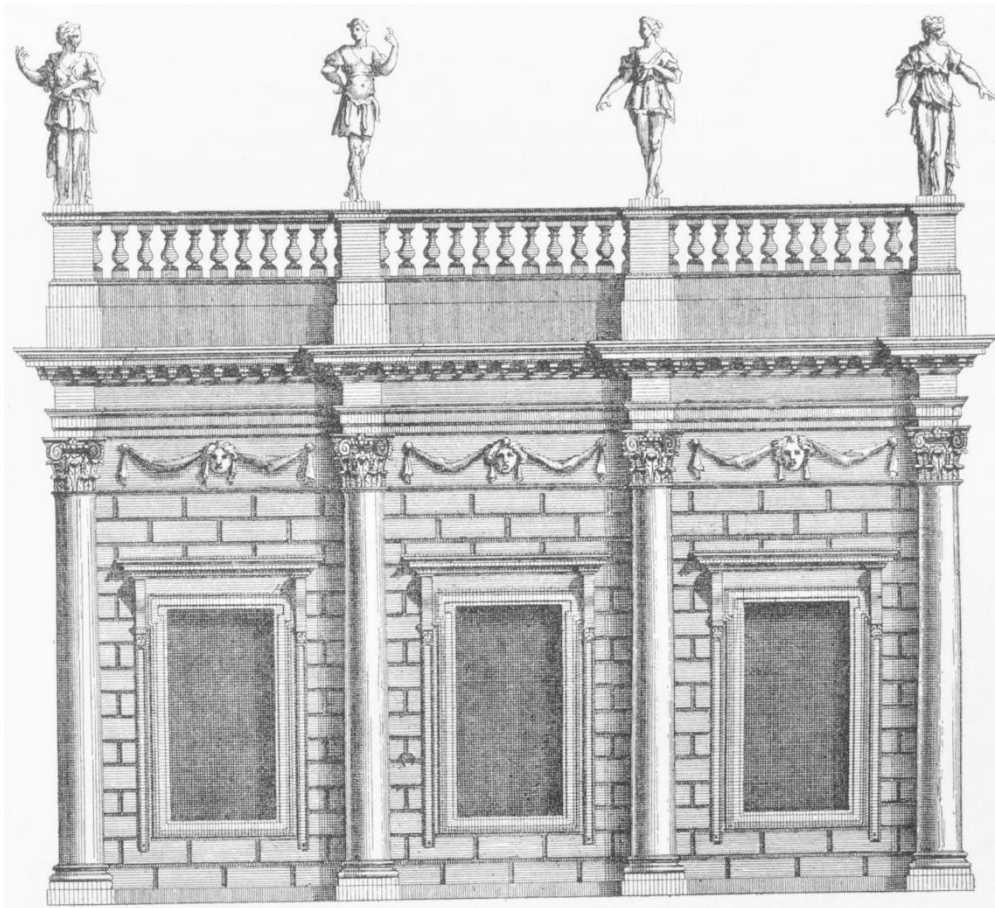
Inigo Jones, *Banqueting House*, Hauptfassade, Whitehall/ London, 1619 – 1622
